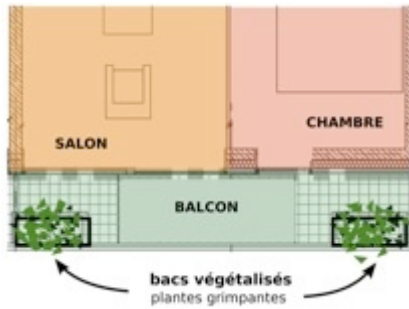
Situation de la façade végétalisée sur les balcons du bâtiment A. Source : Renauld, 2012.
